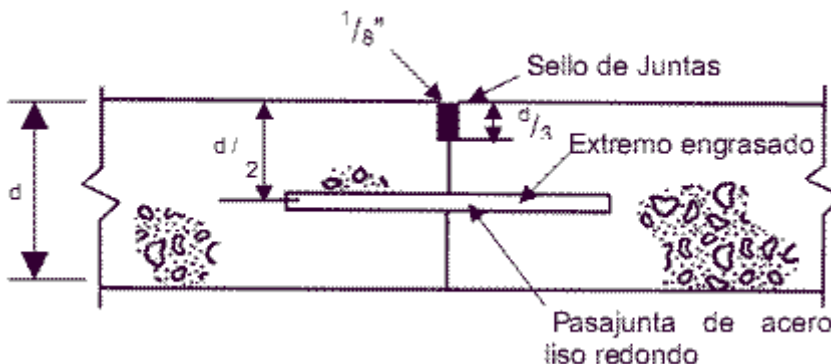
b.14 Junta transversal de contracción con pasajuntas, $1.25 \leq$ relación de largo a ancho ≤ 1.4
